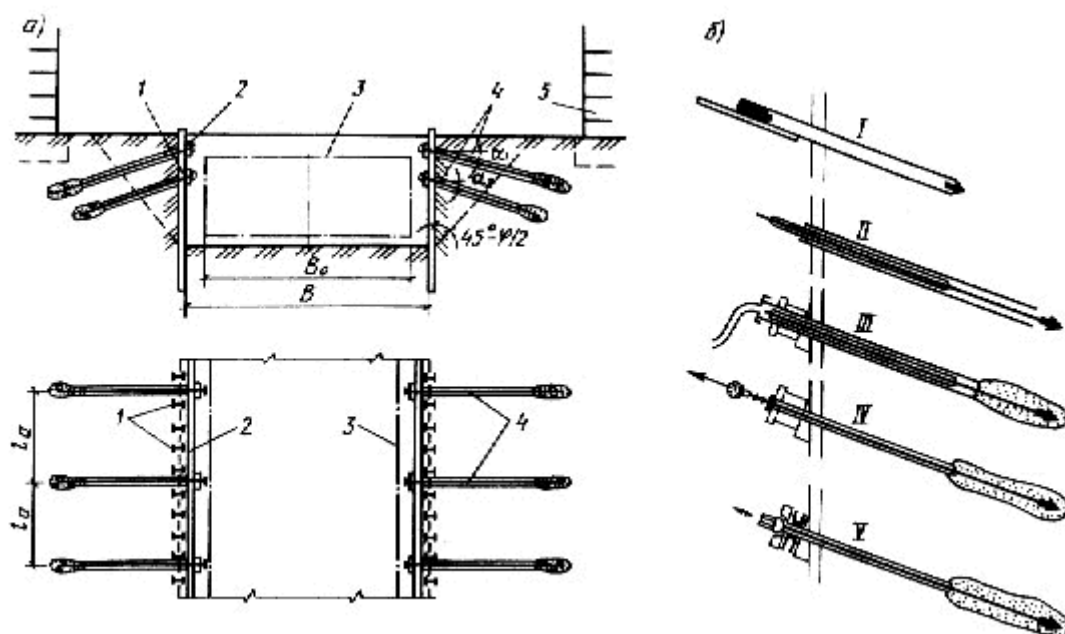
Укрепление стенок котлованов с помощью грунтовых анкеров
